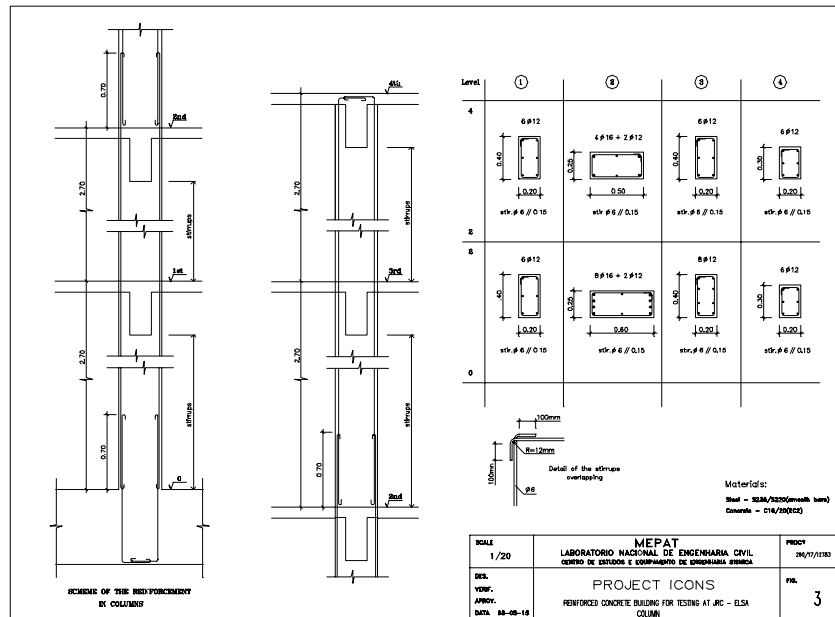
Quadro de pilares e pormenorização da sua armadura
